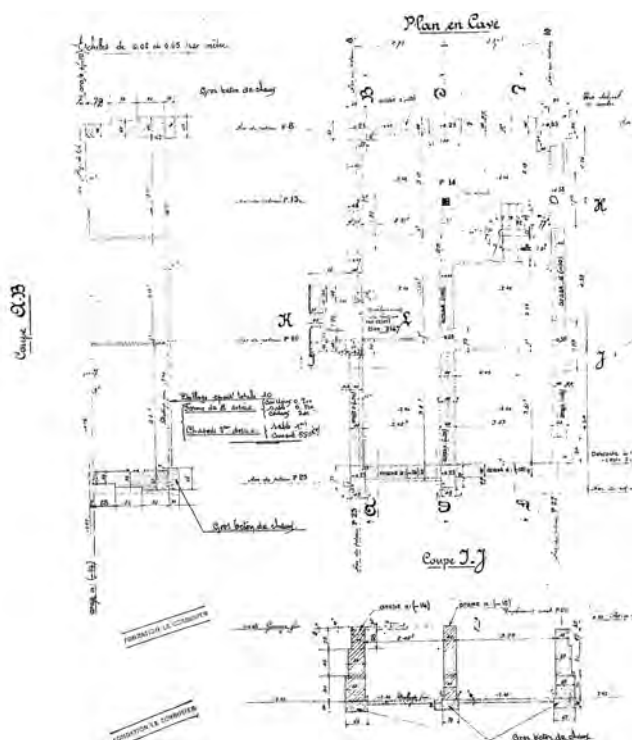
Detalle del plano de replanteo de sótano de la *Villa Savoye* (FLC-H1-13-300). Fuente: Fondation Le Corbusier.
